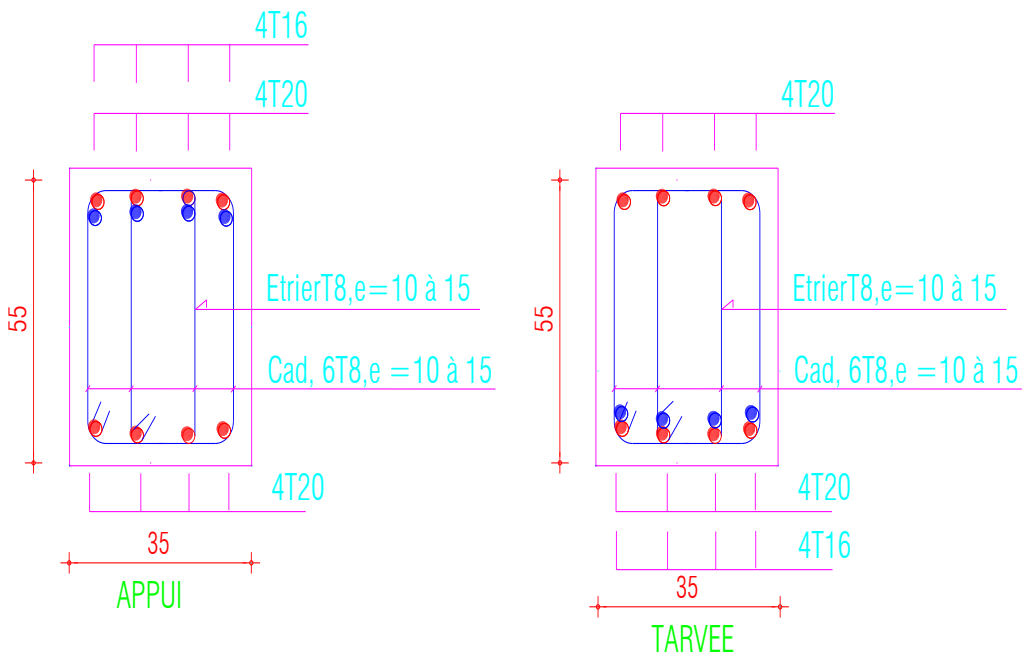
Ferrailage poutre secondaire liée avec voile (35x55)
